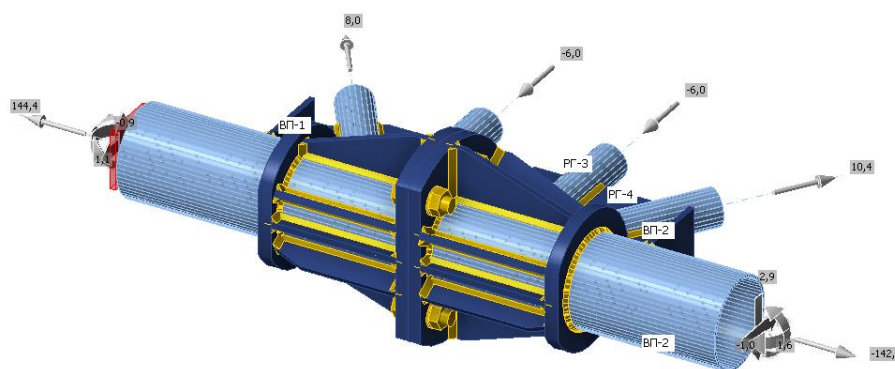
Монтажний стик нижнього поясу просторового блоку ферми
